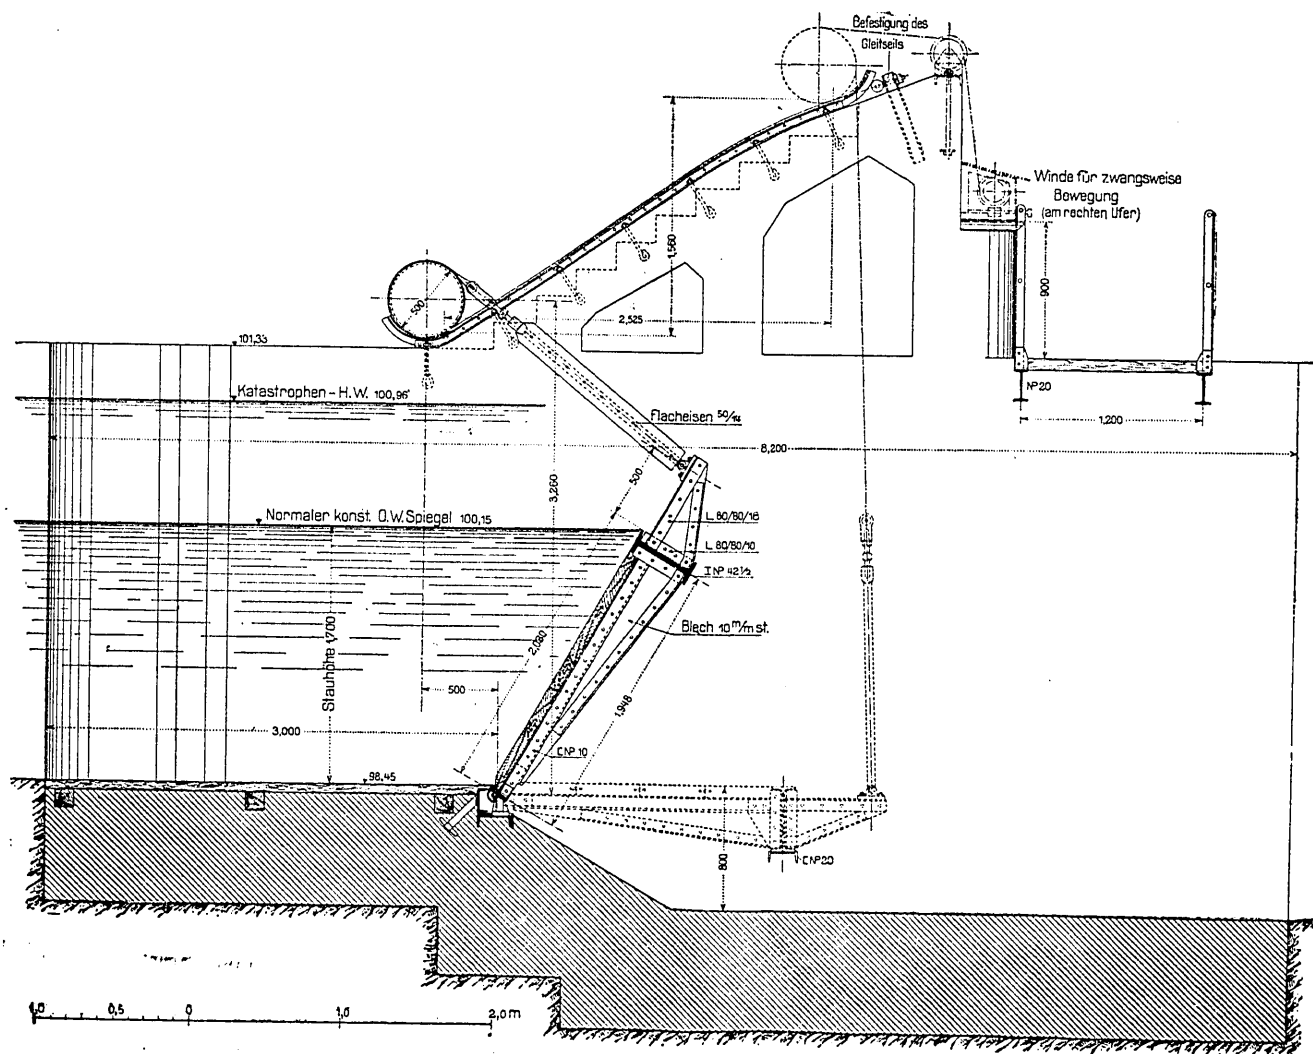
ª—Corte del alza de Grafenau con vista de la vía del lado izquierdo.
